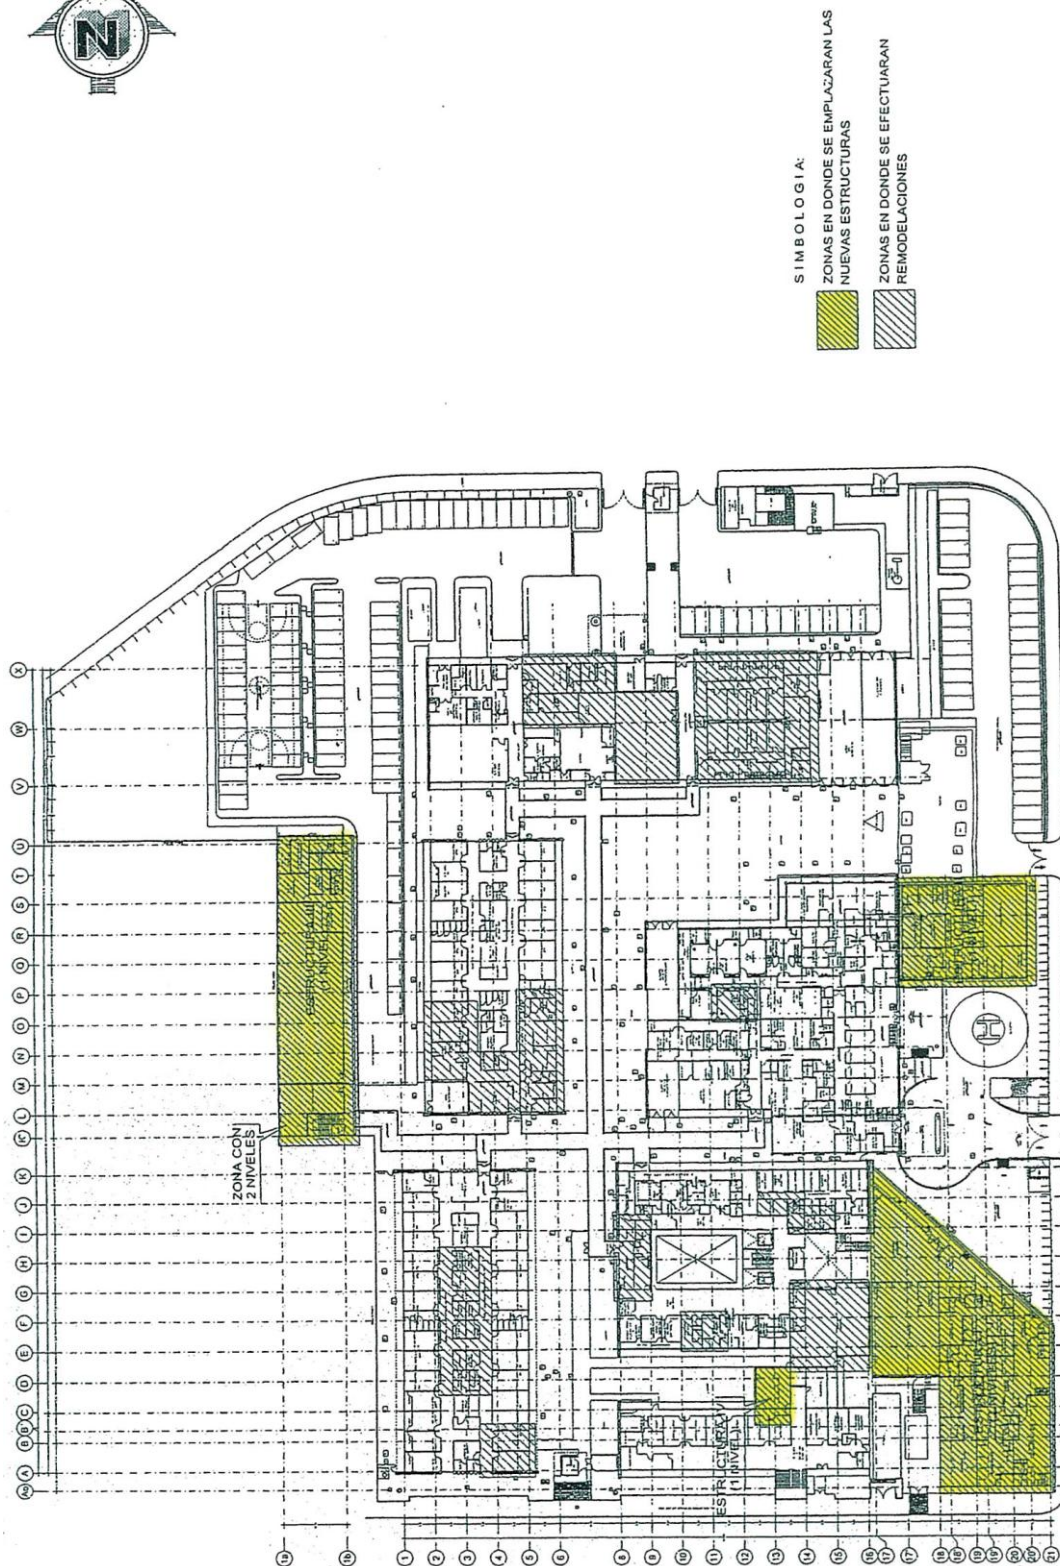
PLANTA ARQUITECTONICA DEL PROYECTO DE AMPLIACION (PLANTA BAJA).
